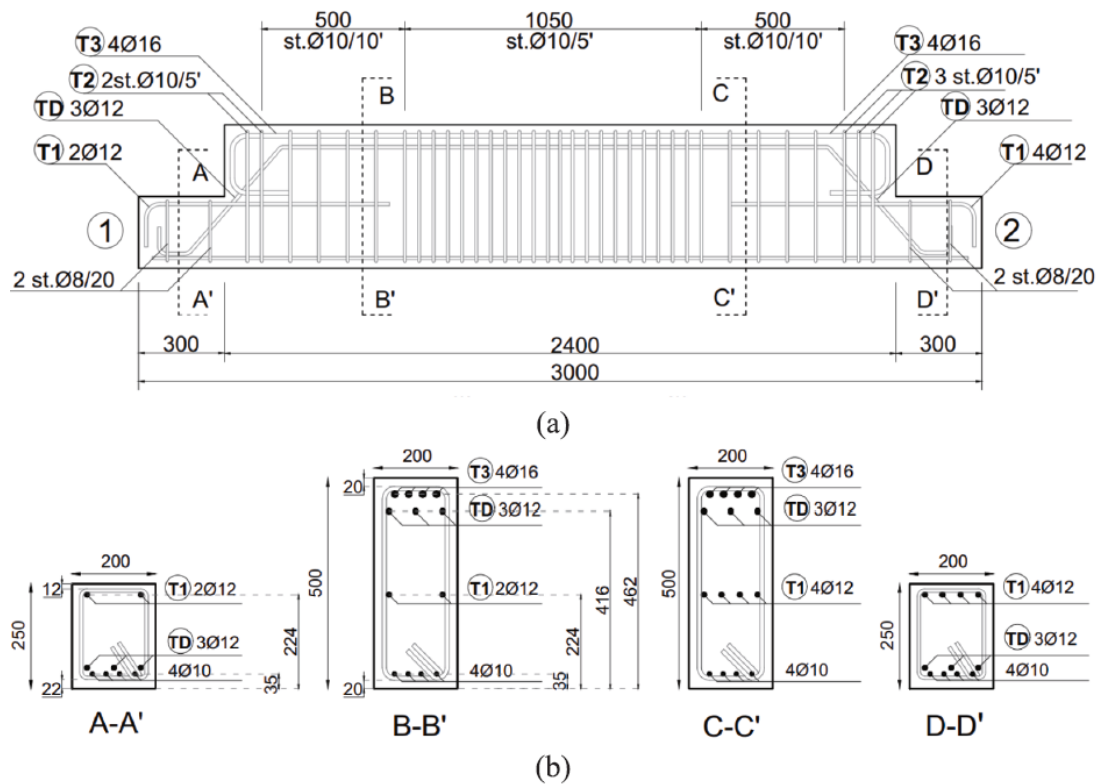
Disposizione delle armature nell'elemento. a) vista longitudinale, b) sezioni trasversali [4]
